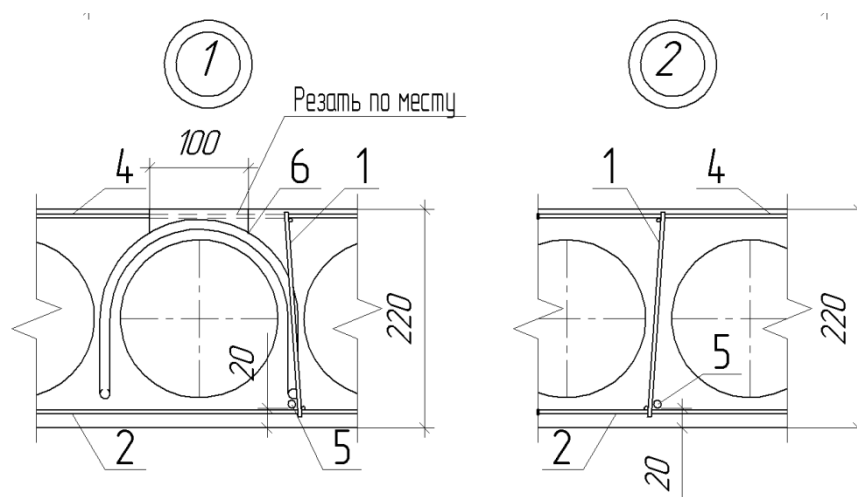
Узел 1 - расположение строповочной петли и узел 2 - крепление сеток к каркасу с поперечной арматурой (обозначение см. рис. 2.5)
